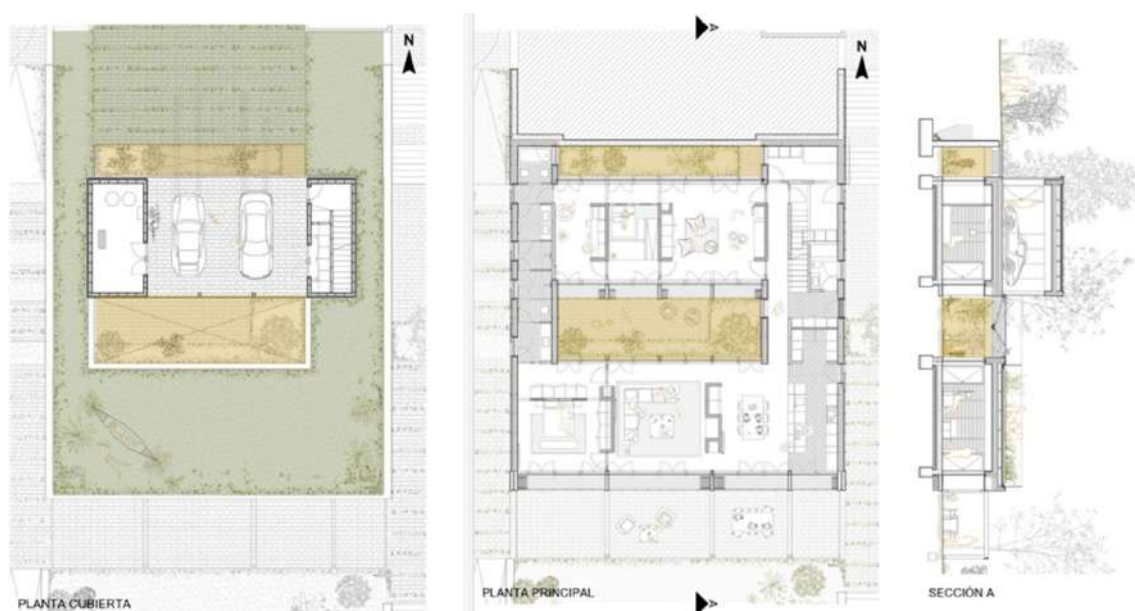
Planta cubierta, planta principal y sección destacando cubierta verde y patios bioclimáticos. Elaboración propia por Slow Studio.
